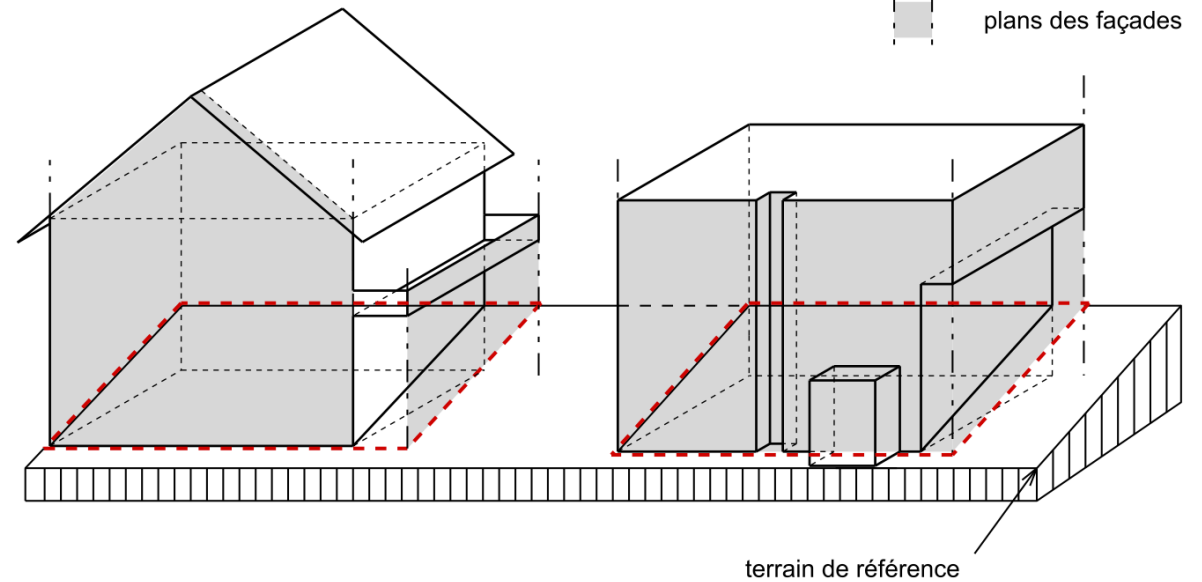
3.3 Plans des façades et projection du pied de façade
